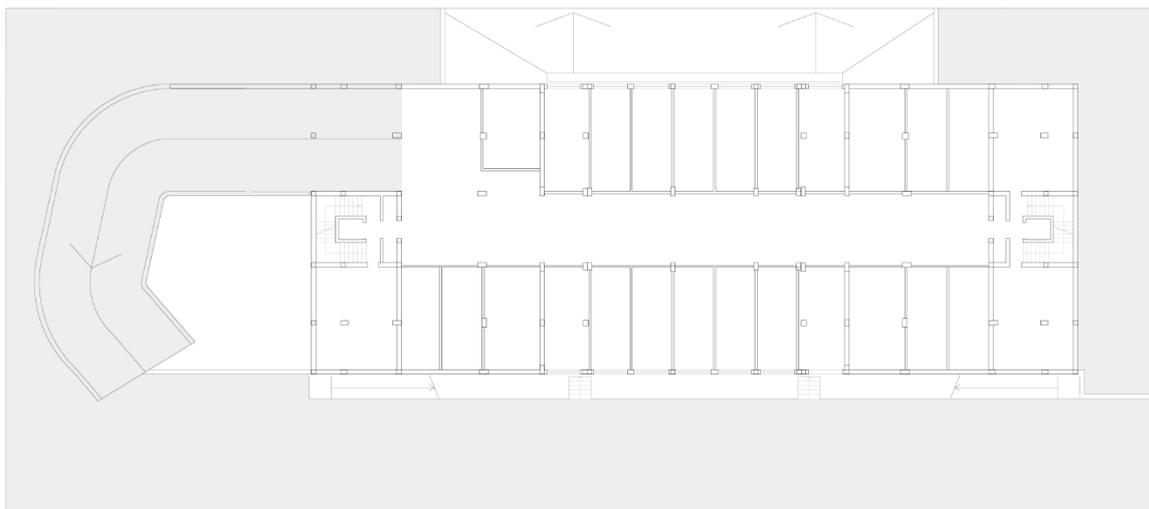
e 18: Rappresentazioni grafiche in scala 1:500 rappresentati il primo piano e il piano seminterrato della struttura ATER, nella pagina successiva i prospetti.
